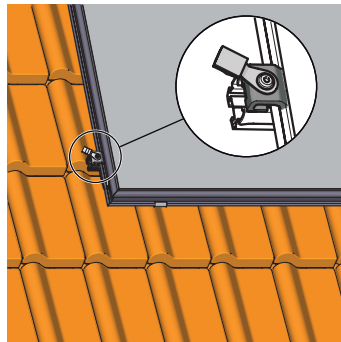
De platte collector plaatsen en in de juiste stand brengen
